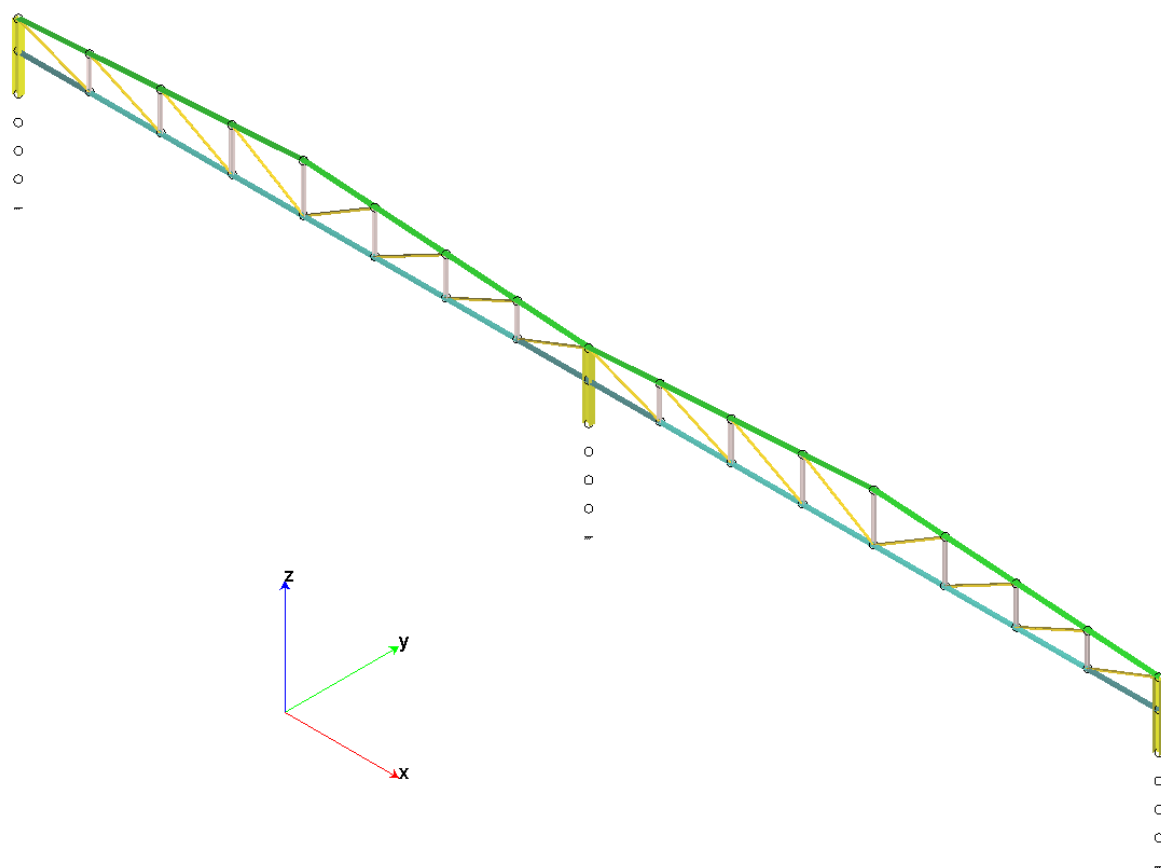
Vista estrusa del modello 3D dell'elevazione – particolare capriata metallica tipologica
